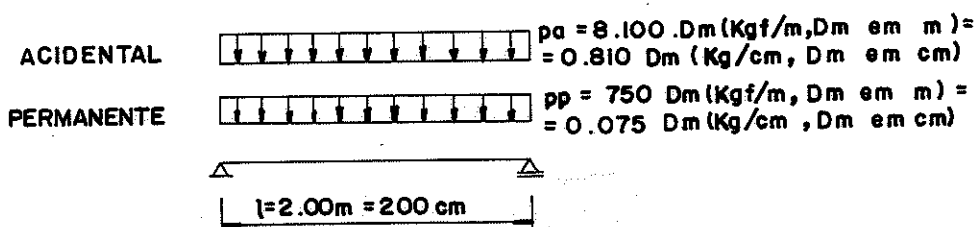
ESQUEMA ESTÁTICO E CARREGAMENTOS DA VIGA DO TABULEIRO
